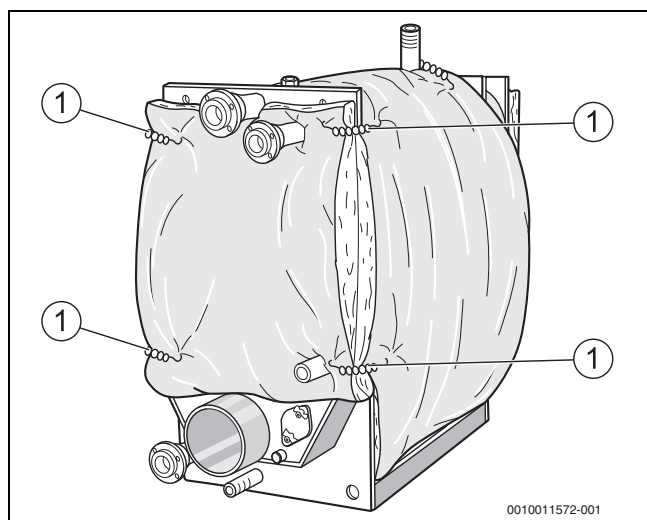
Poser l'isolation thermique du panneau arrière et fixer
